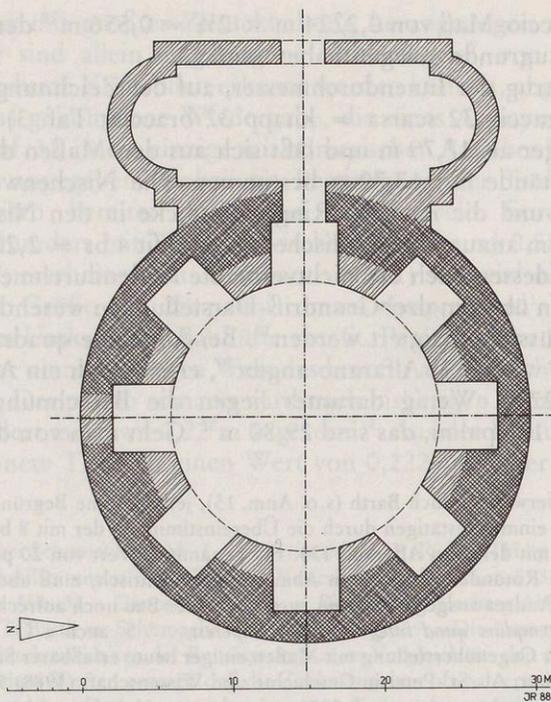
S. Andrea, Grundriß, Rekonstruktion, M 1:500
